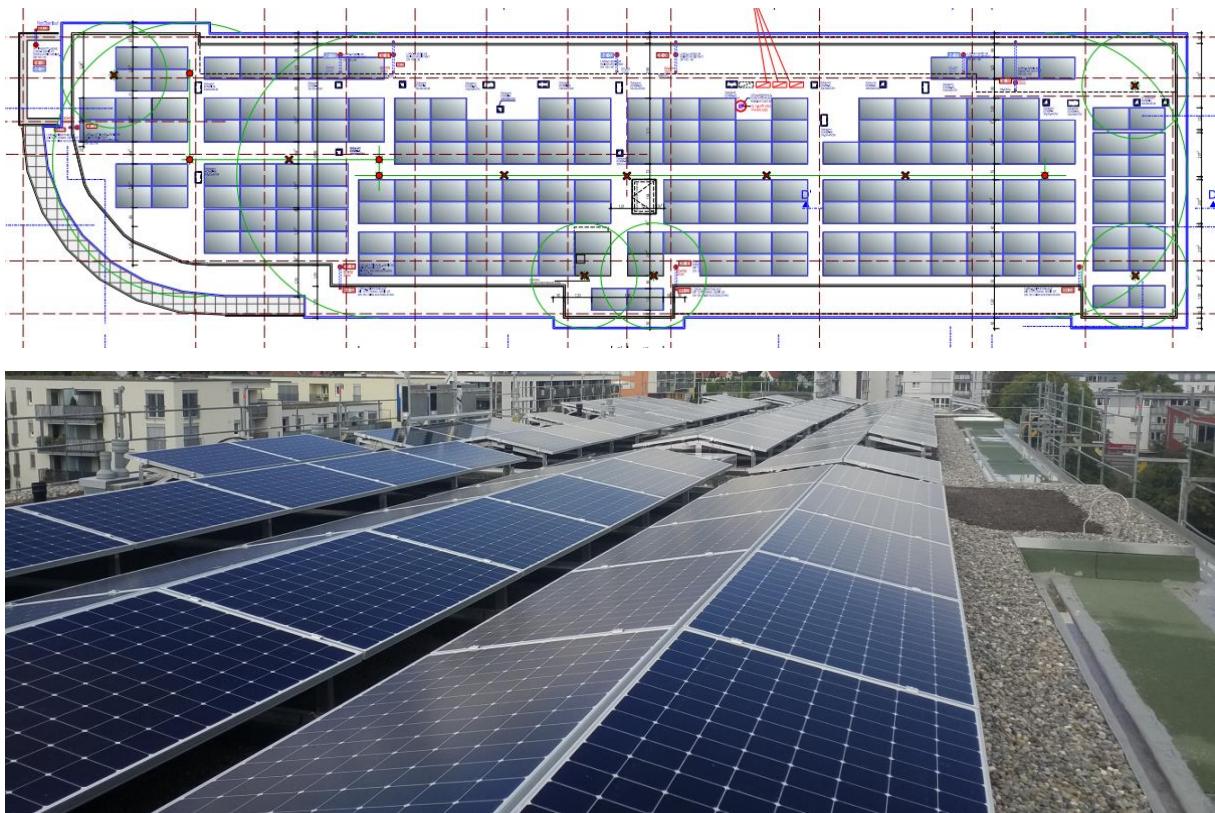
Plan und Foto der PV-Dachanlage (Quelle: EGS-plan)
